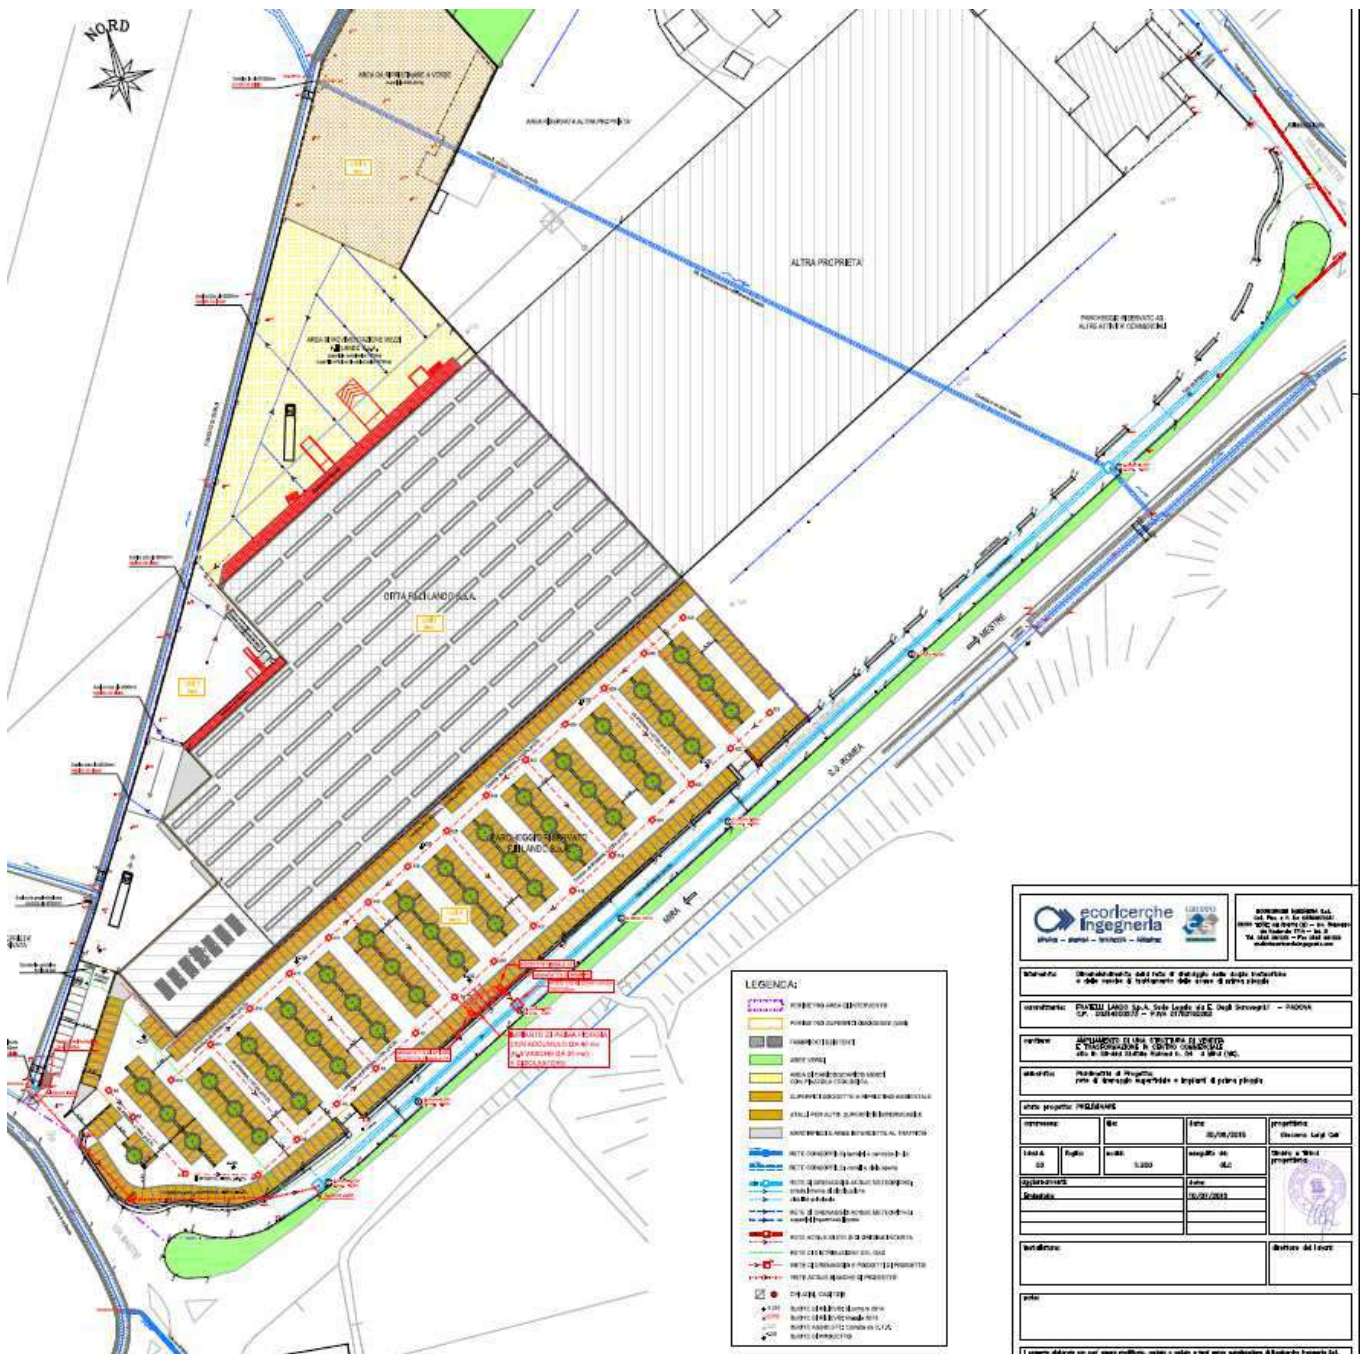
Estratto Tav. 03Planimetria di progetto rete acque meteoriche e impianti di prima pioggia
